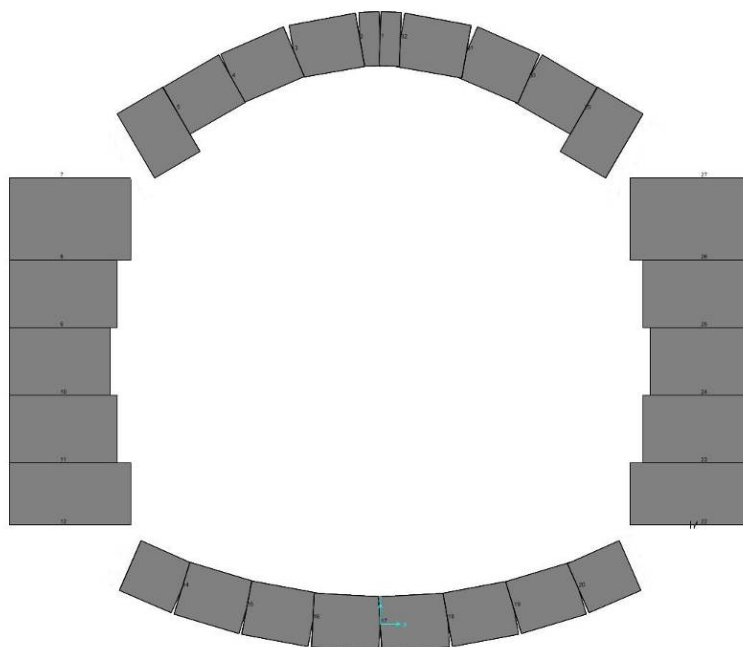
Modello strutturale per classi di carpenteria degli elementi beam.
